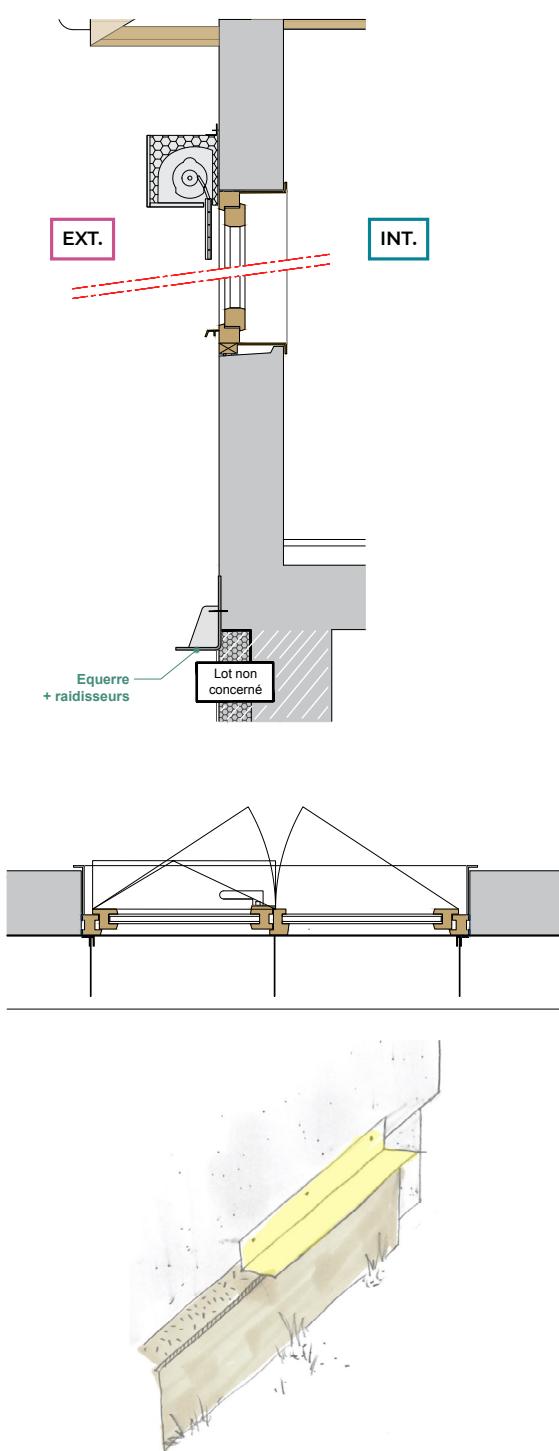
Fixation de l'équerre métallique (au niveau des dalles de planchers)
